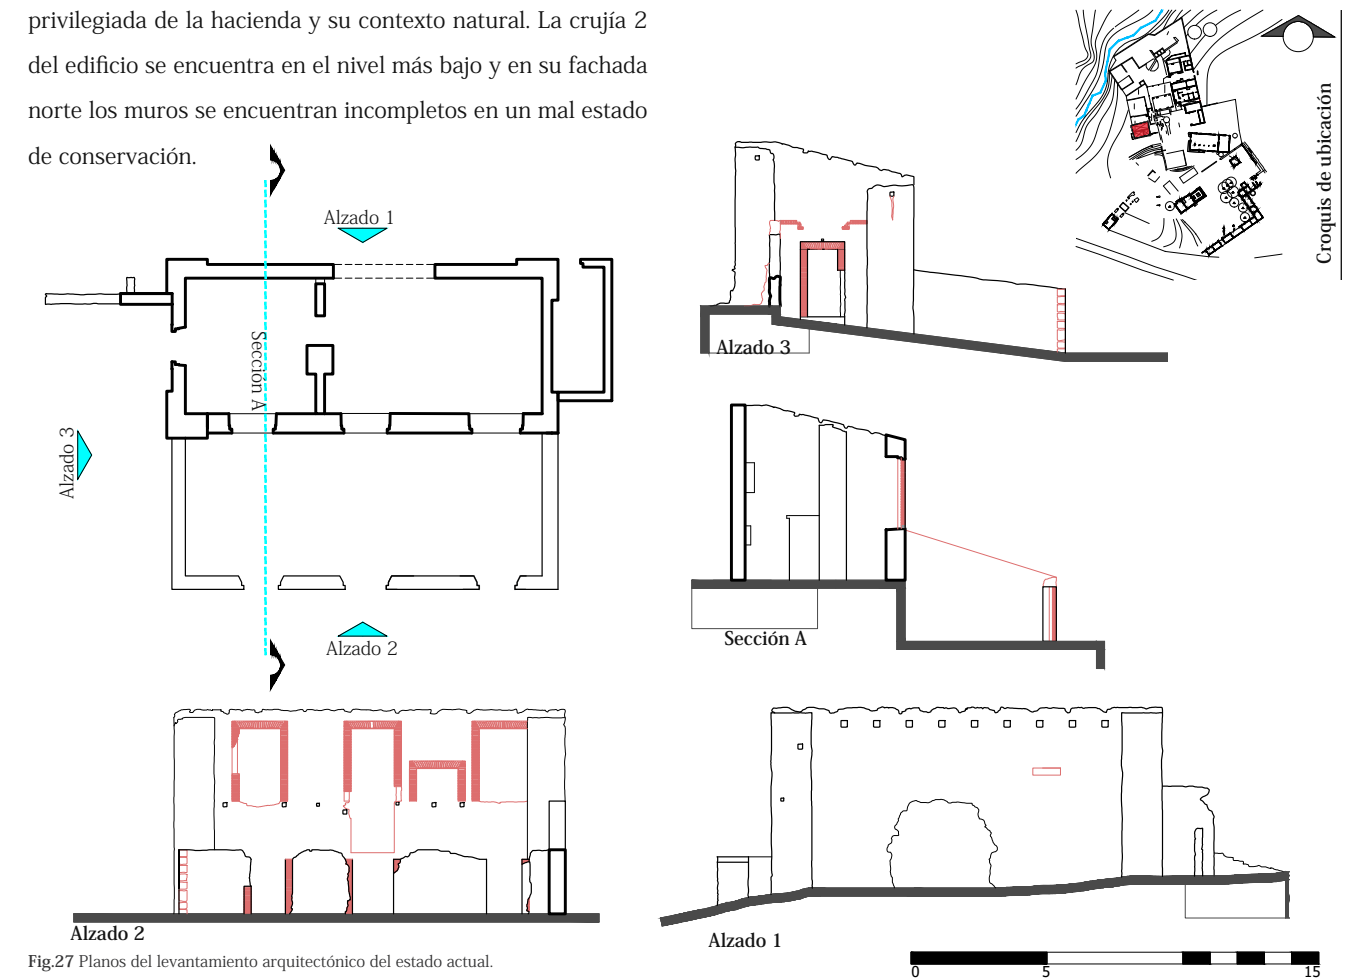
Planos del levantamiento arquitectónico del estado actual.
